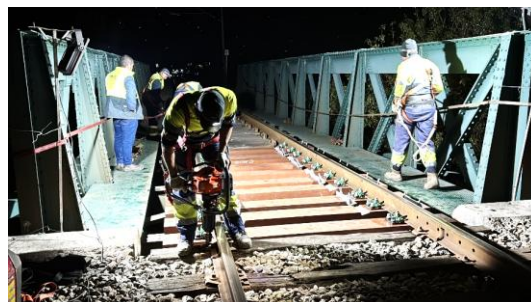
Desaperto das fixações nas travessas localizadas nos encontros
